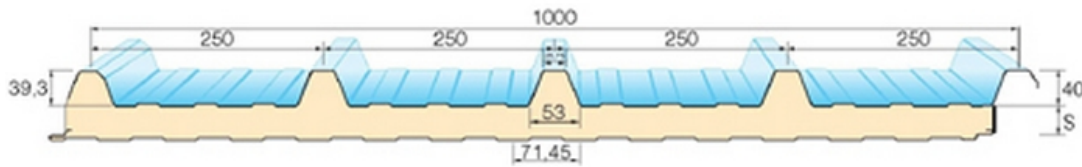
Painel sandwich de 30mm, tipo “Alaço” C5-1000 [22]
